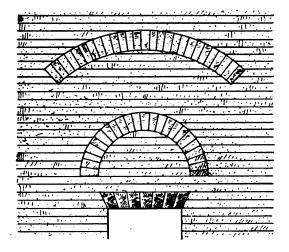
Gewölbefugen mit parallelen Seitenflächen (Keilsteine).
